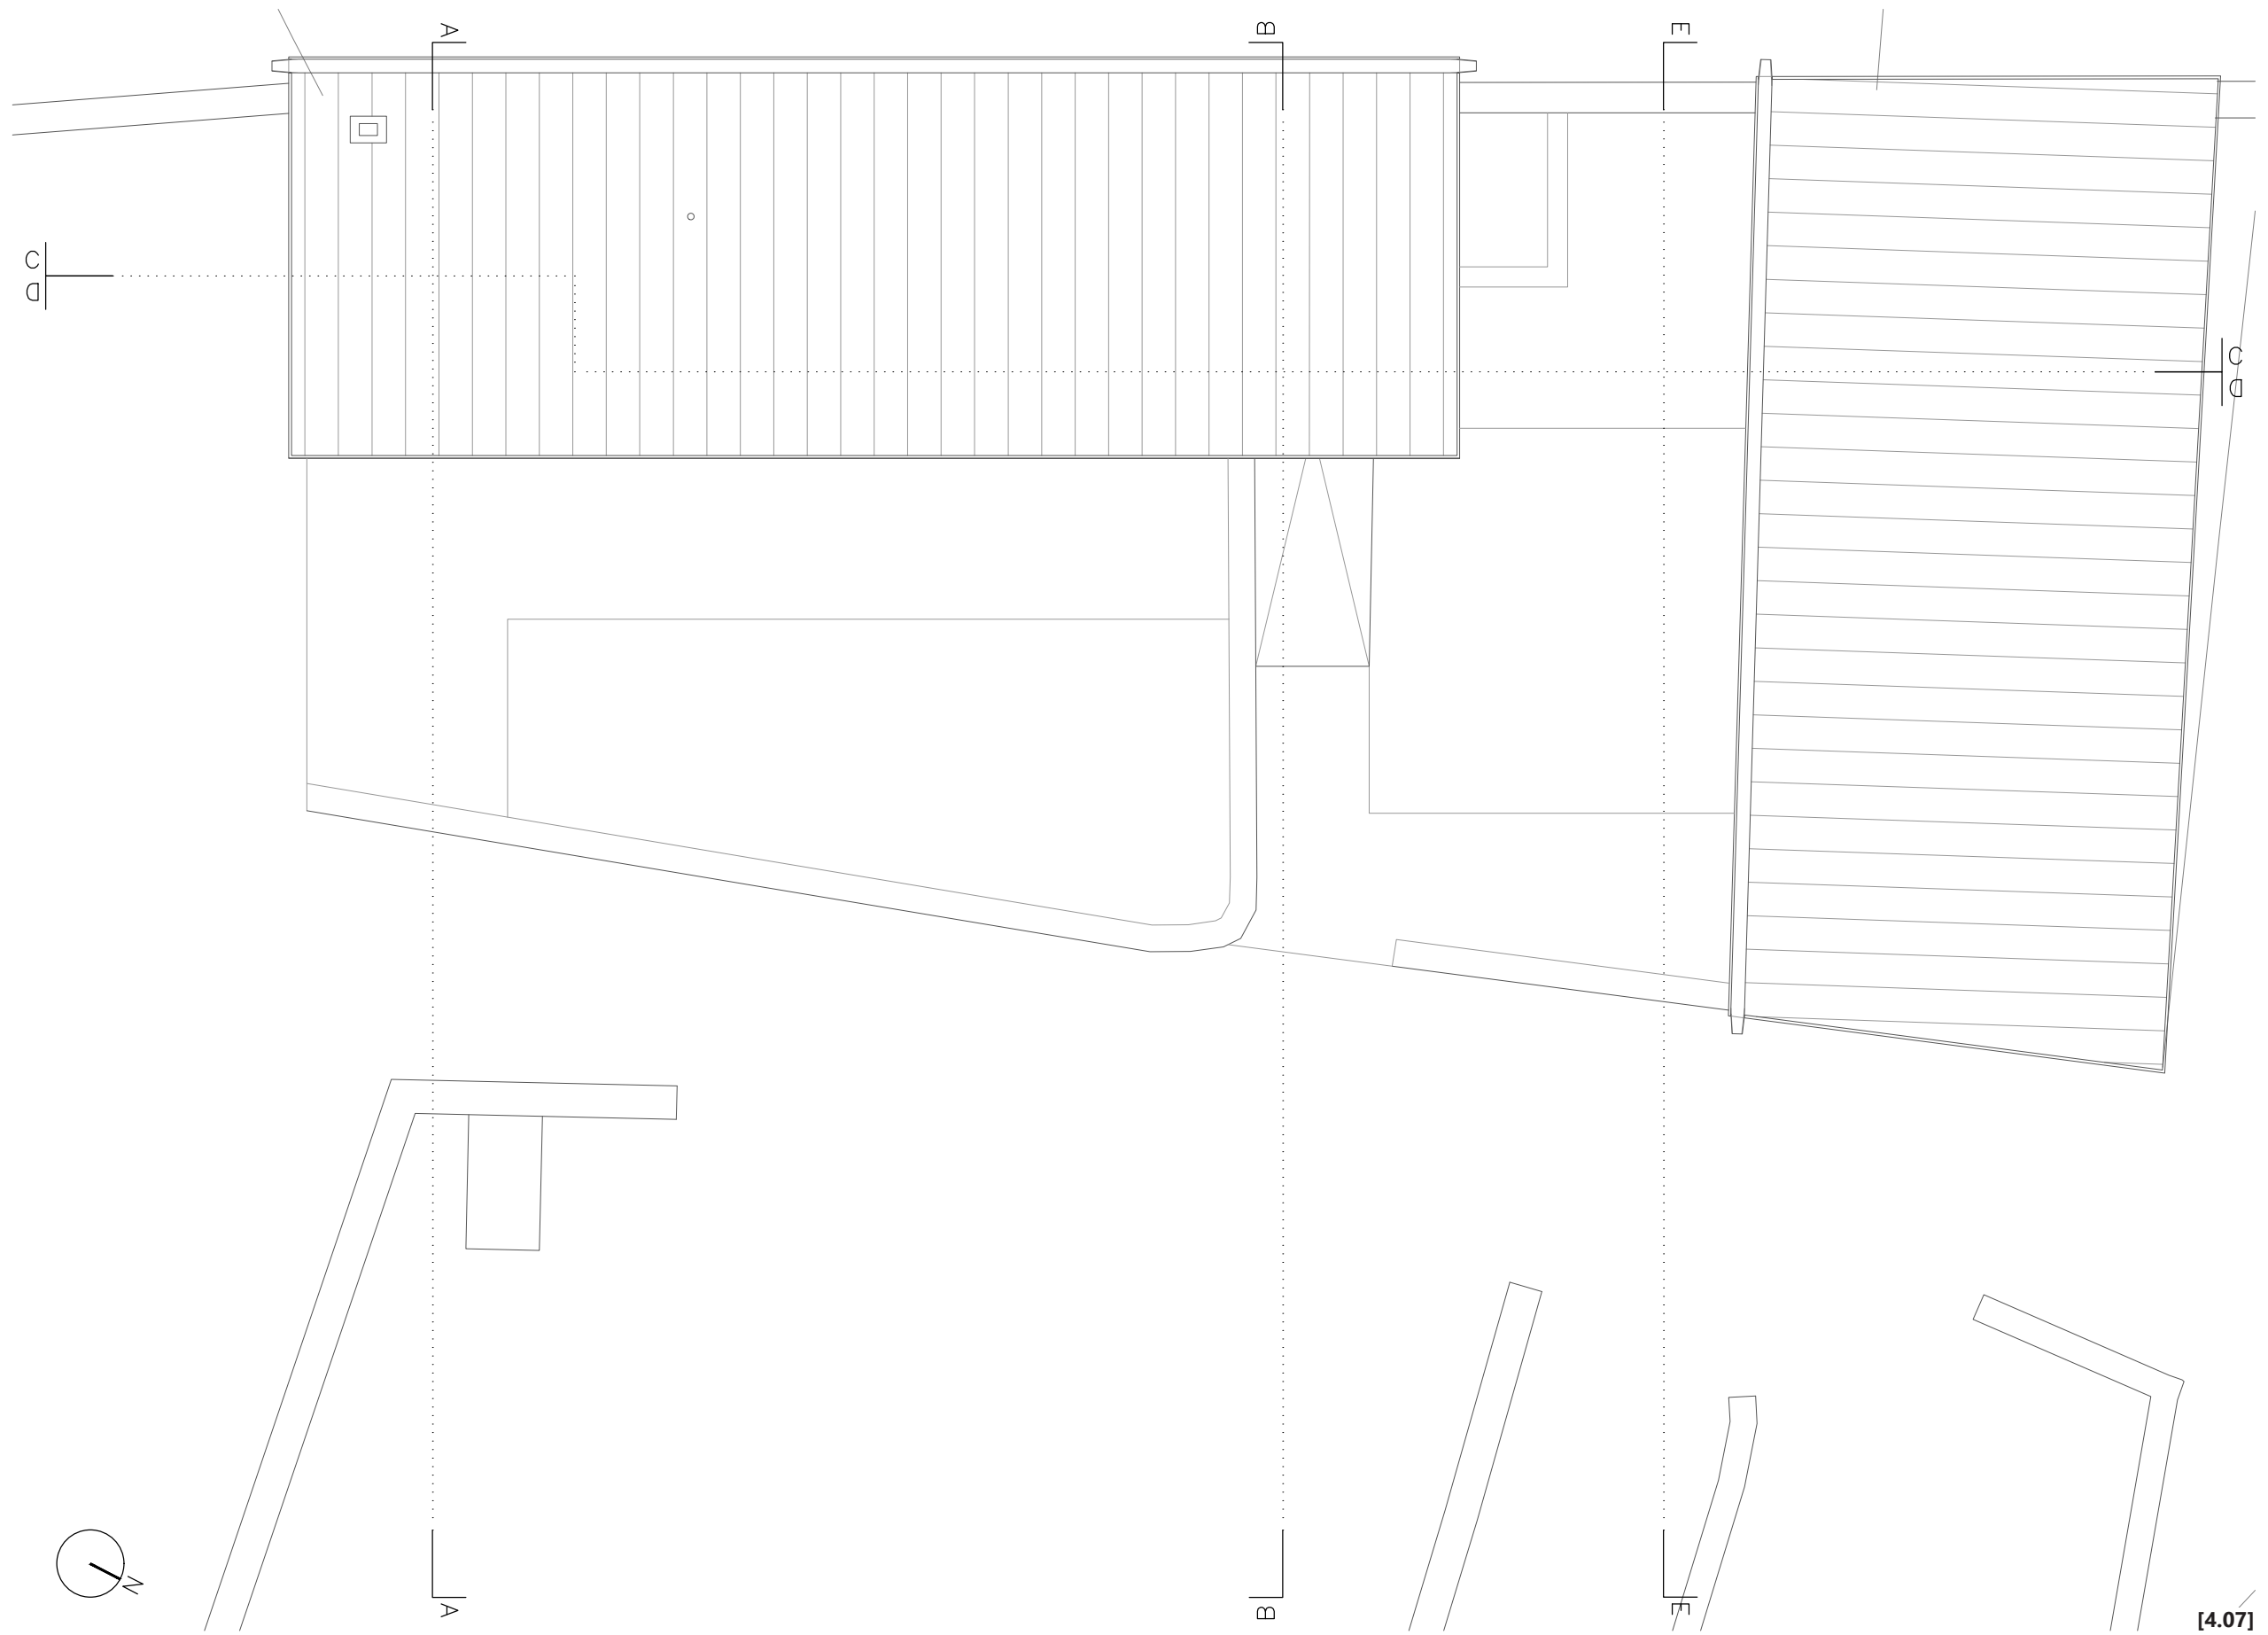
Reabilitação da casa - Planta de Cobertura. Esc.1/100
